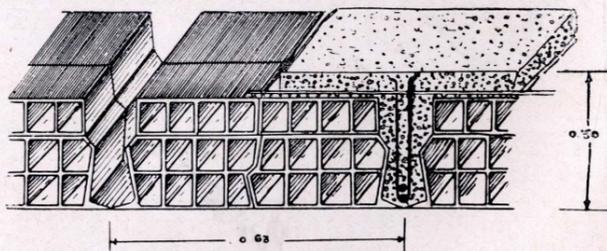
Struttura dei solai in calcestruzzo armato a laterizi vuoti.
